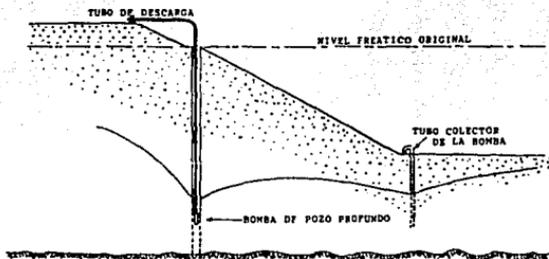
DRENAJE POR MEDIO DE BOMBAS DE POZO PROFUNDO
